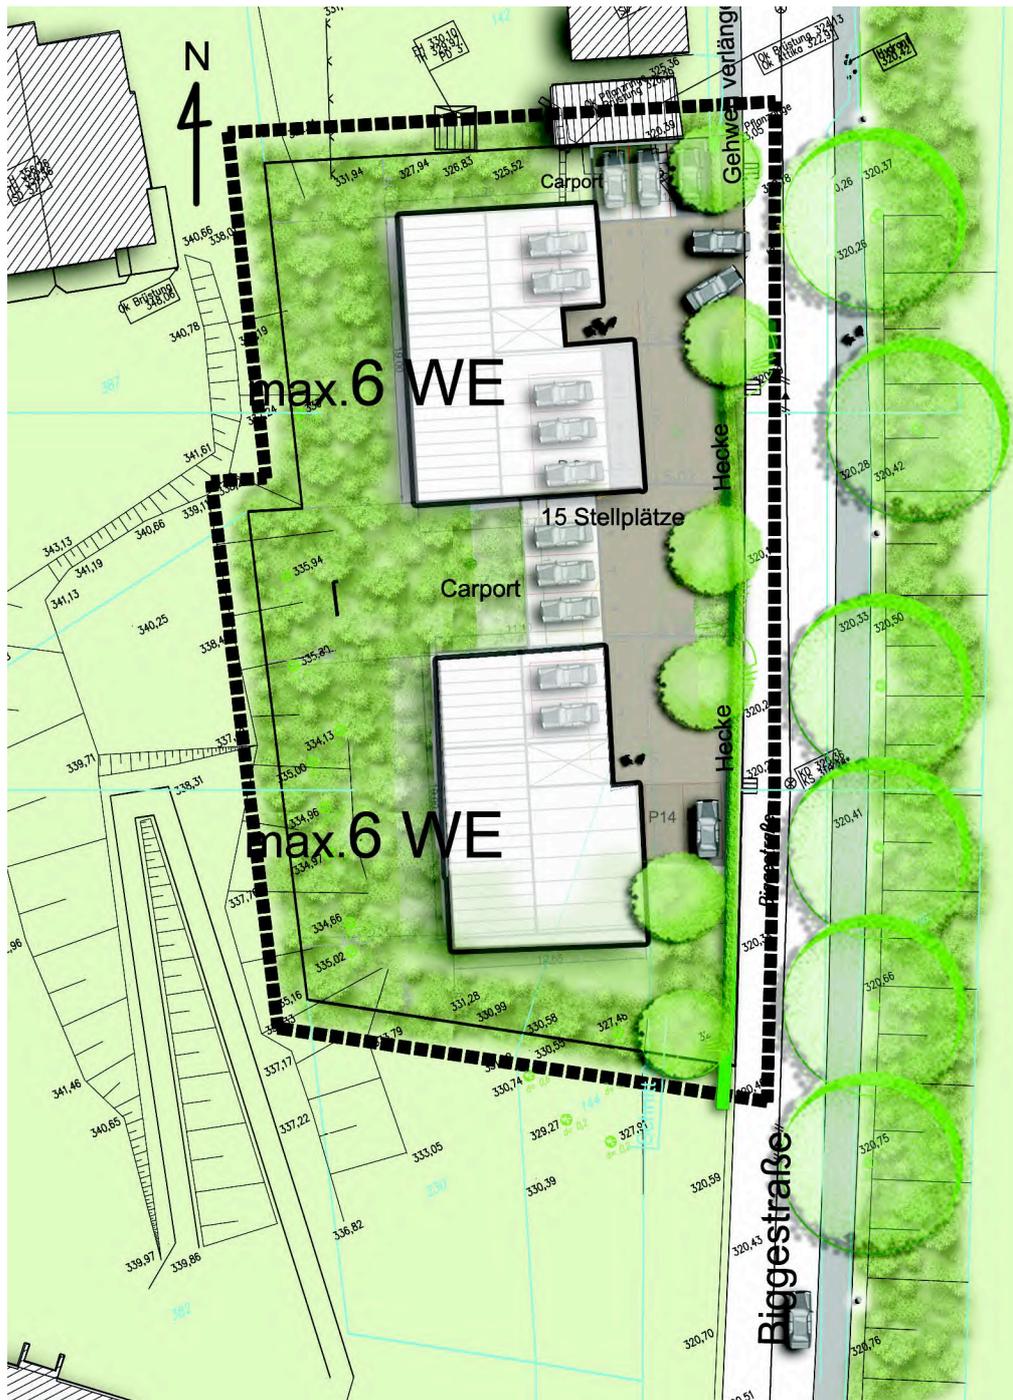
Geplante Bebauung mit zwei Baukörpern und 15 Stellplätze an der Biggestraße
